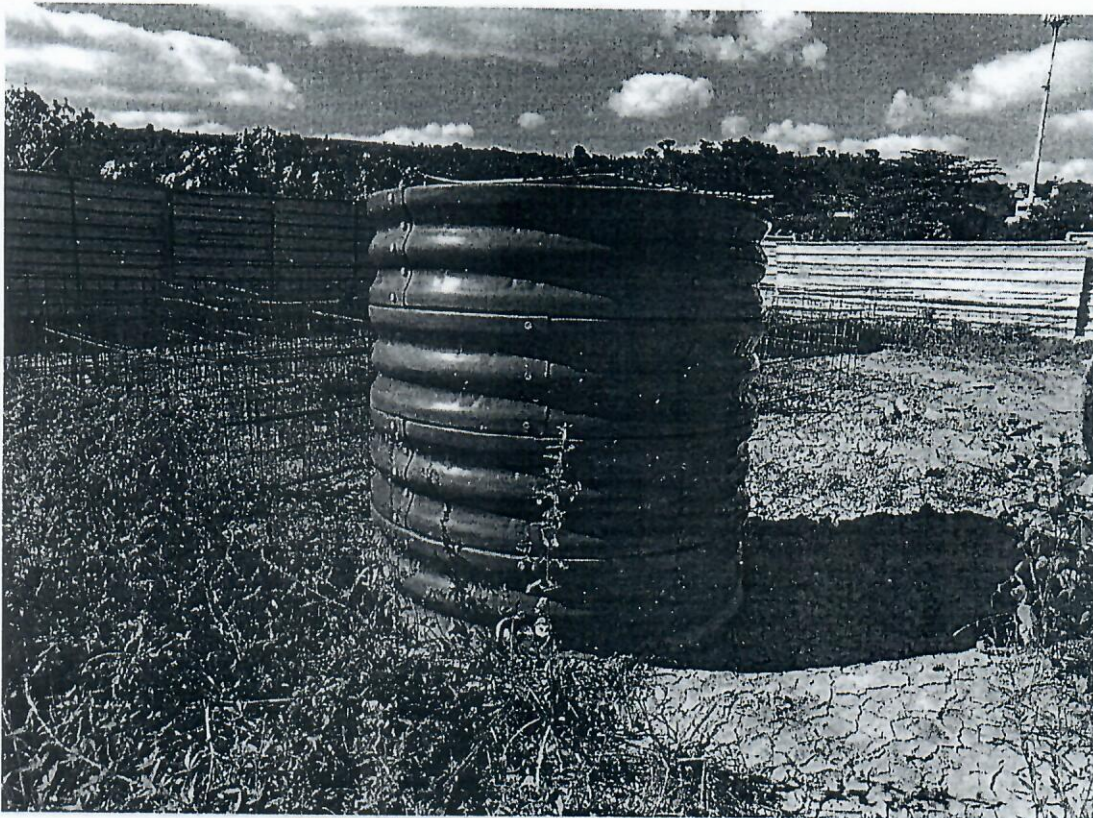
MATERIAL TUNNEL LINER NÃO EXECUTADO
